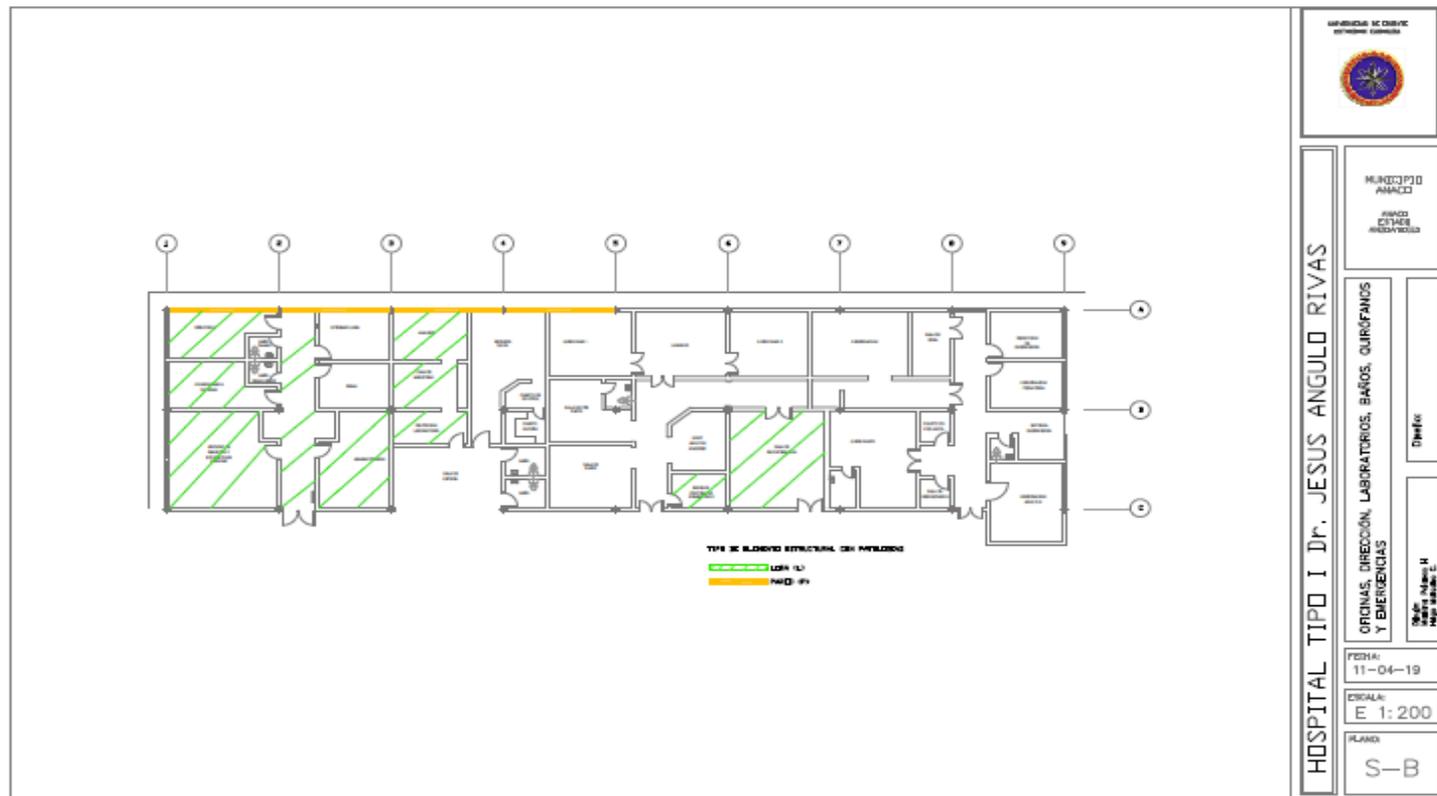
Vista de planta sección B del hospital Dr. Jesús Angulo Rivas.
